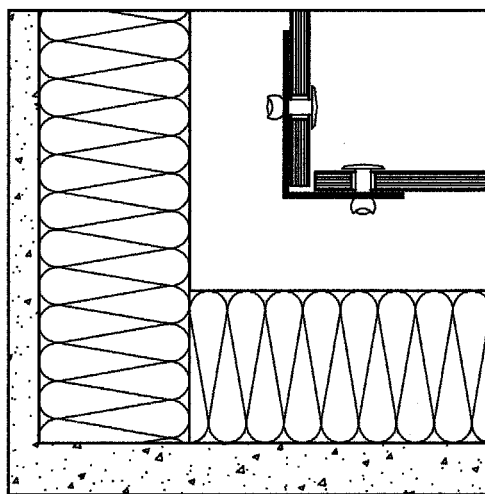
binnenhoek (horizontale doorsnede)
